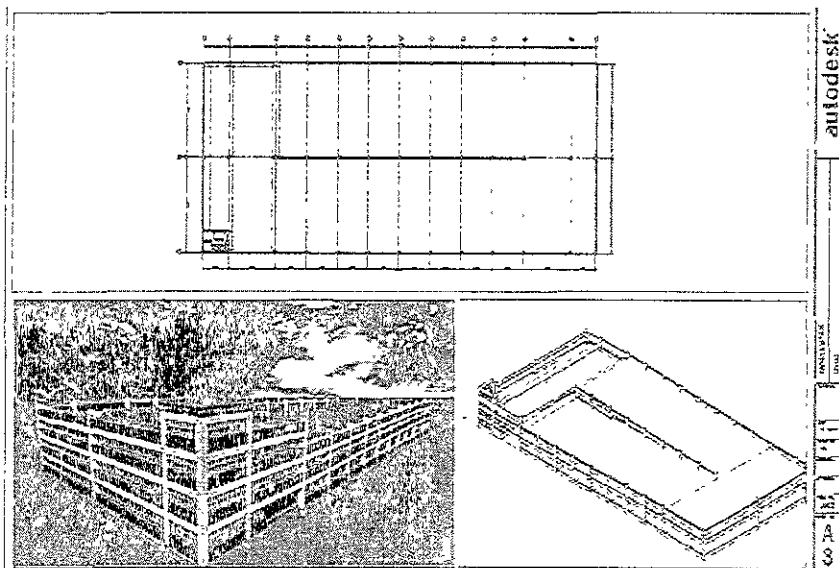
Vistas de proyecto desarrollado en AutoCAD Architectural Desktop²¹.
